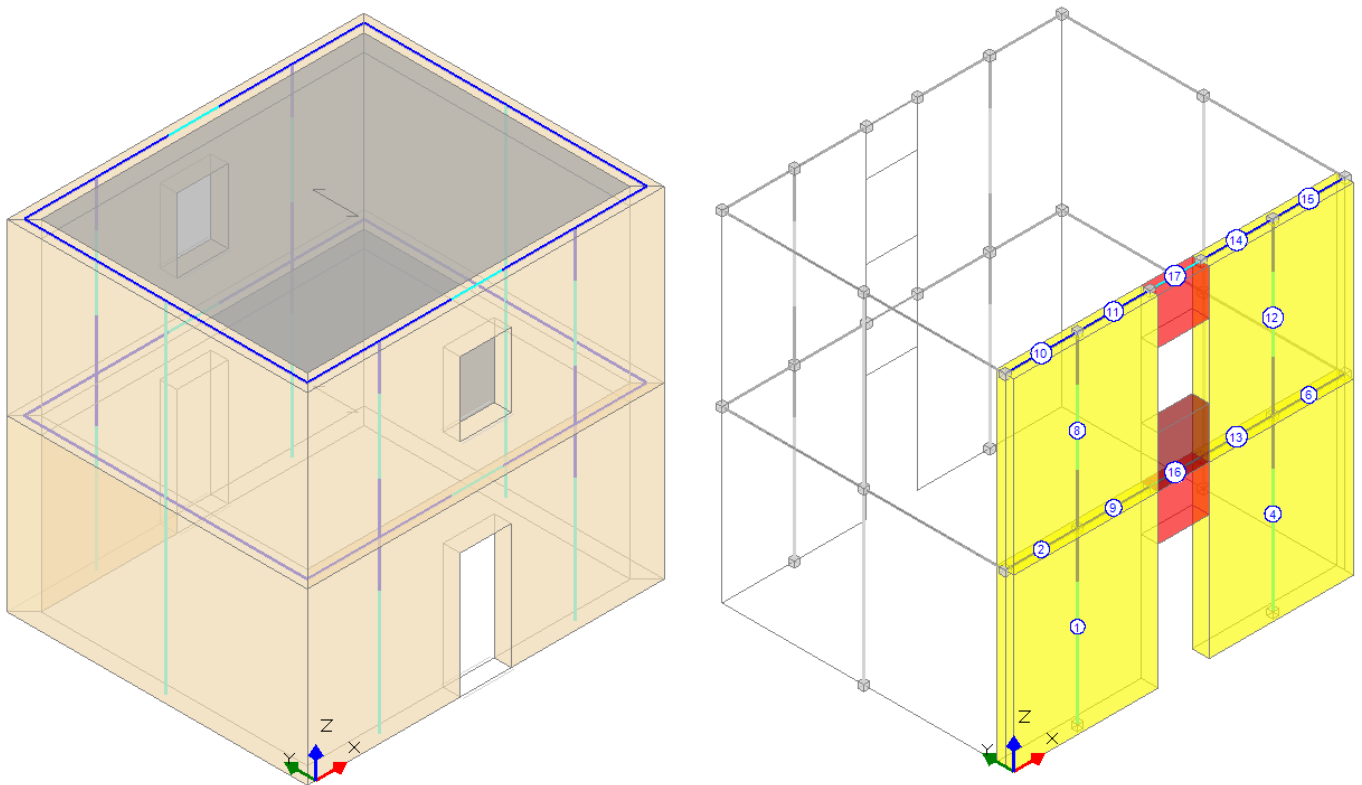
Parete A: modellazione architettonica e strutturale
